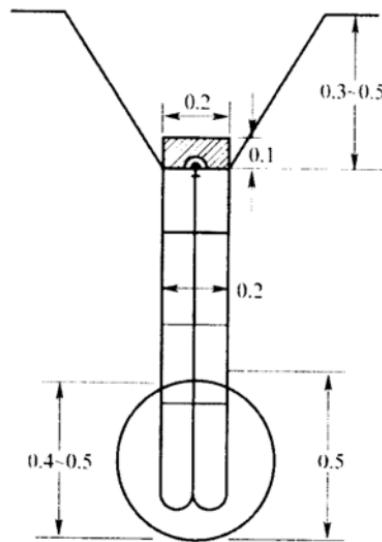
爆破型混凝土柱普通水准标石 (单位:m)
